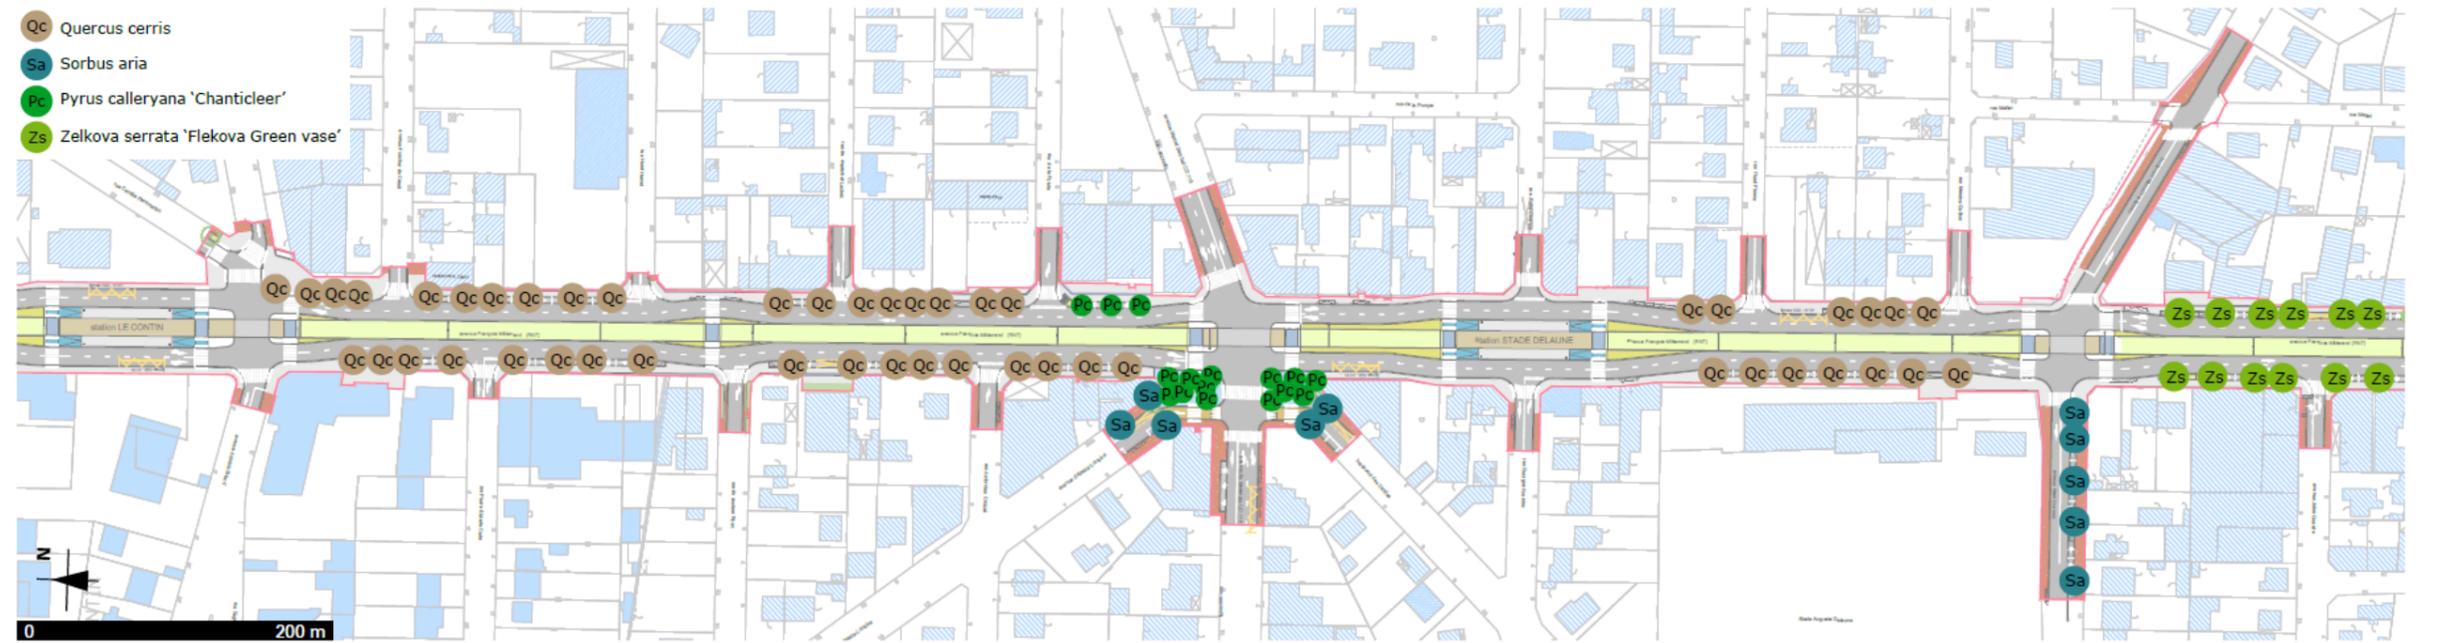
Plantations prévues le long de la RN7 section avenue François Mitterrand (planche 2/6)
